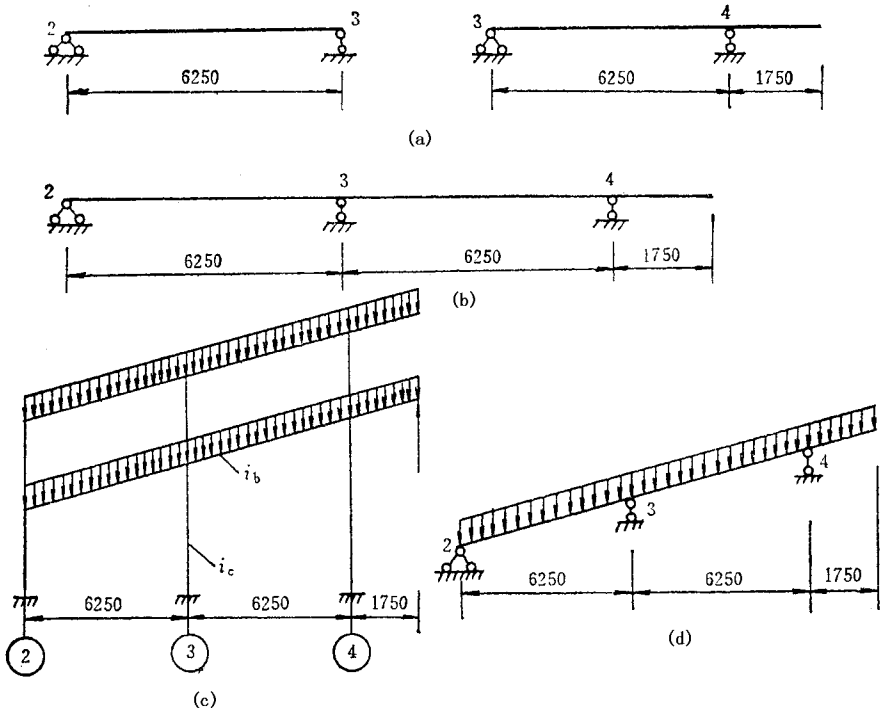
钢筋混凝土栈桥简支梁、连续梁及框架计算模型
